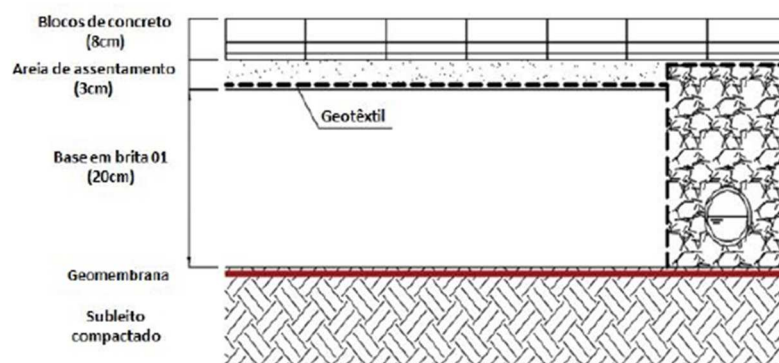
Secção transversal da estrutura do pavimento (Ono et al., 2017).
